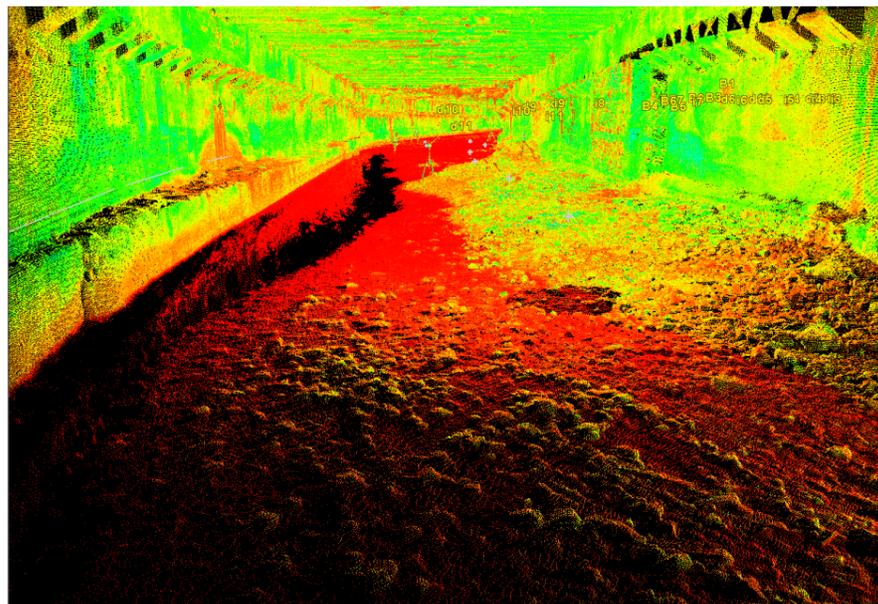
Cubrimiento del Huerva. Láser escáner. Estructura metálica anclada al muro (2)
